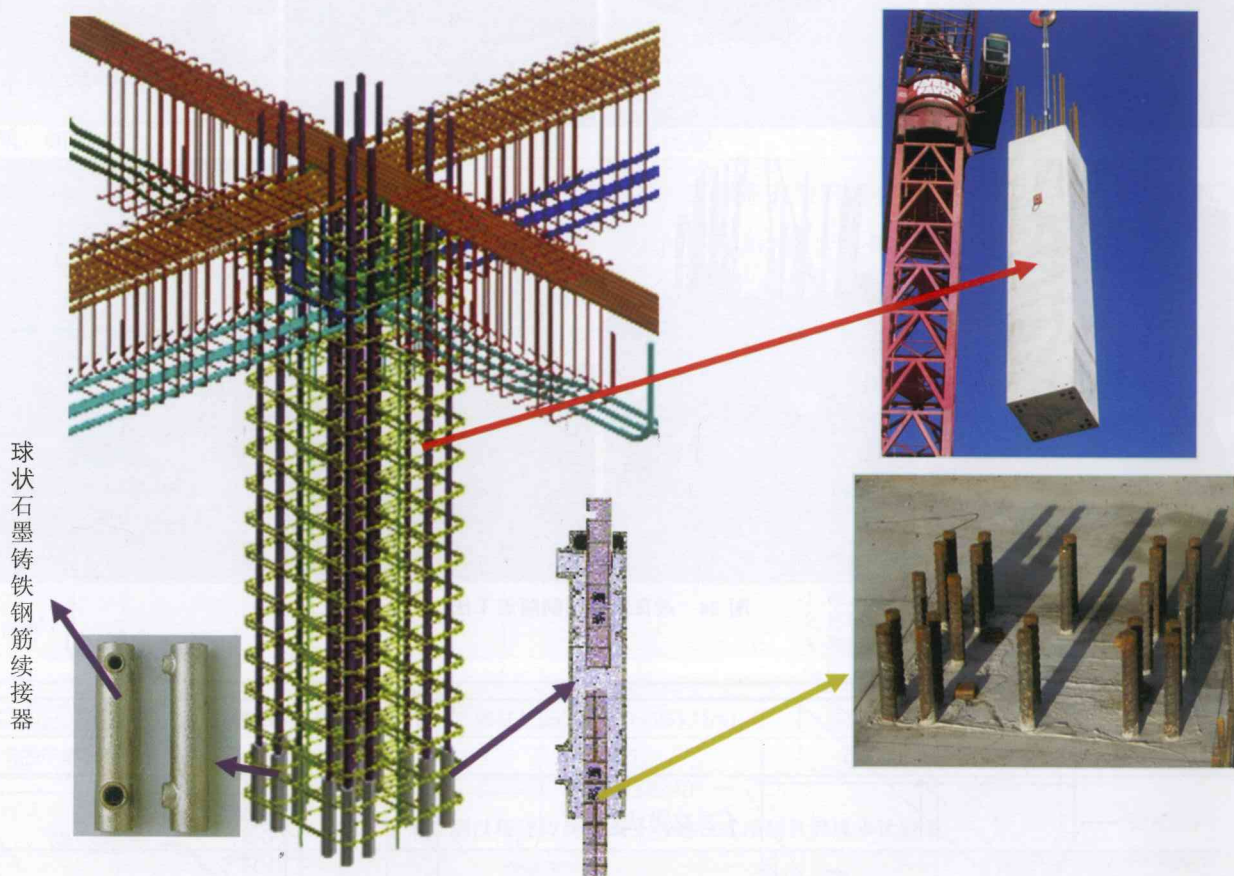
预制柱钢筋连接采用球状石墨铸铁钢筋续接器
